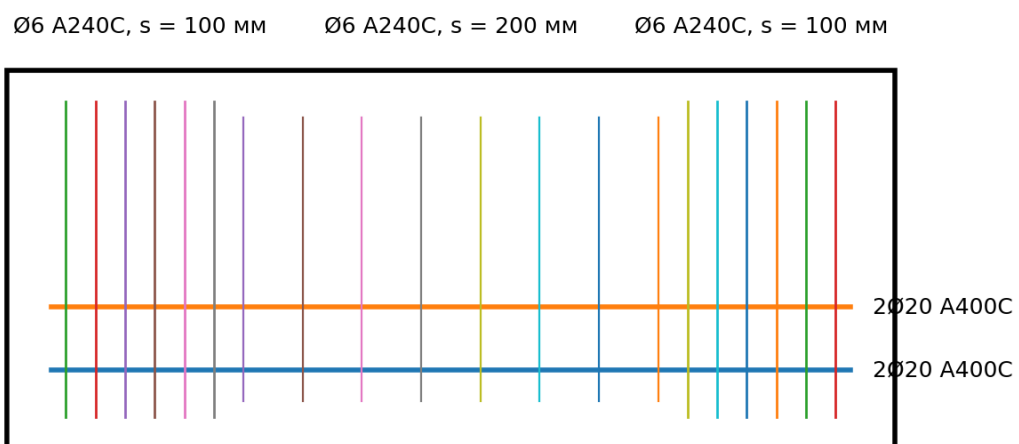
Схема армування сходового маршу
